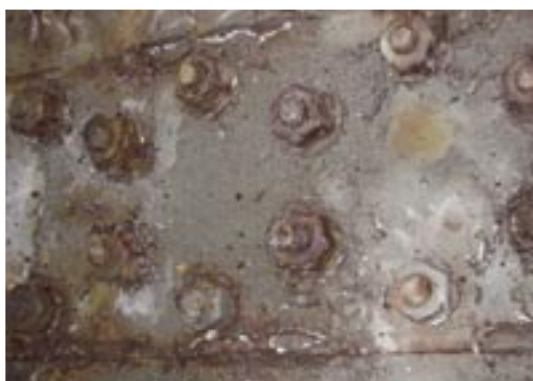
ボルトに断面欠損を伴う錆が発生した例
